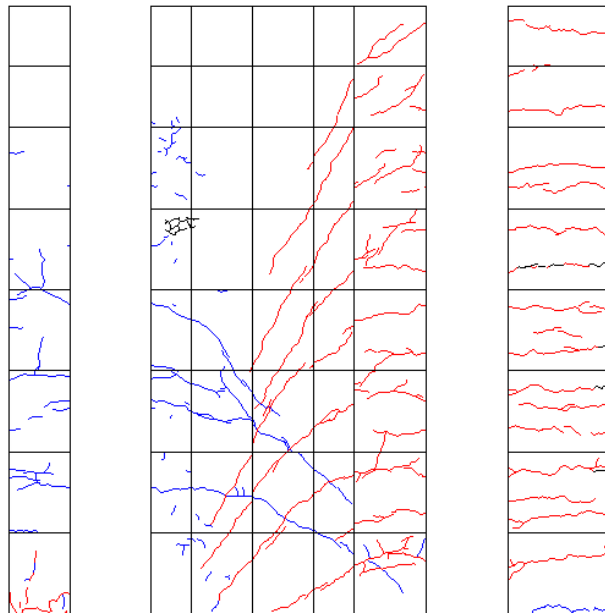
R=-1/67②ひび割れ図
